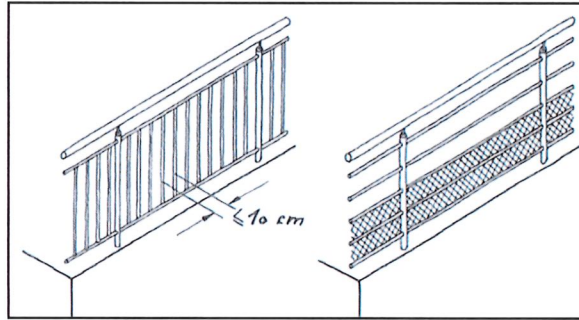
Géométrie des garde-corps (entraxe entre barreaux verticaux et dispositif empêchant d'y grimper)
